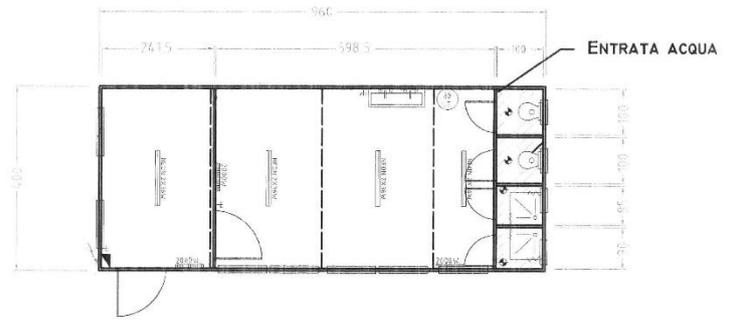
A destra: pianta e prospetto principale del prefabbricato esistente. Fonte: geom. Sergio Trucco
